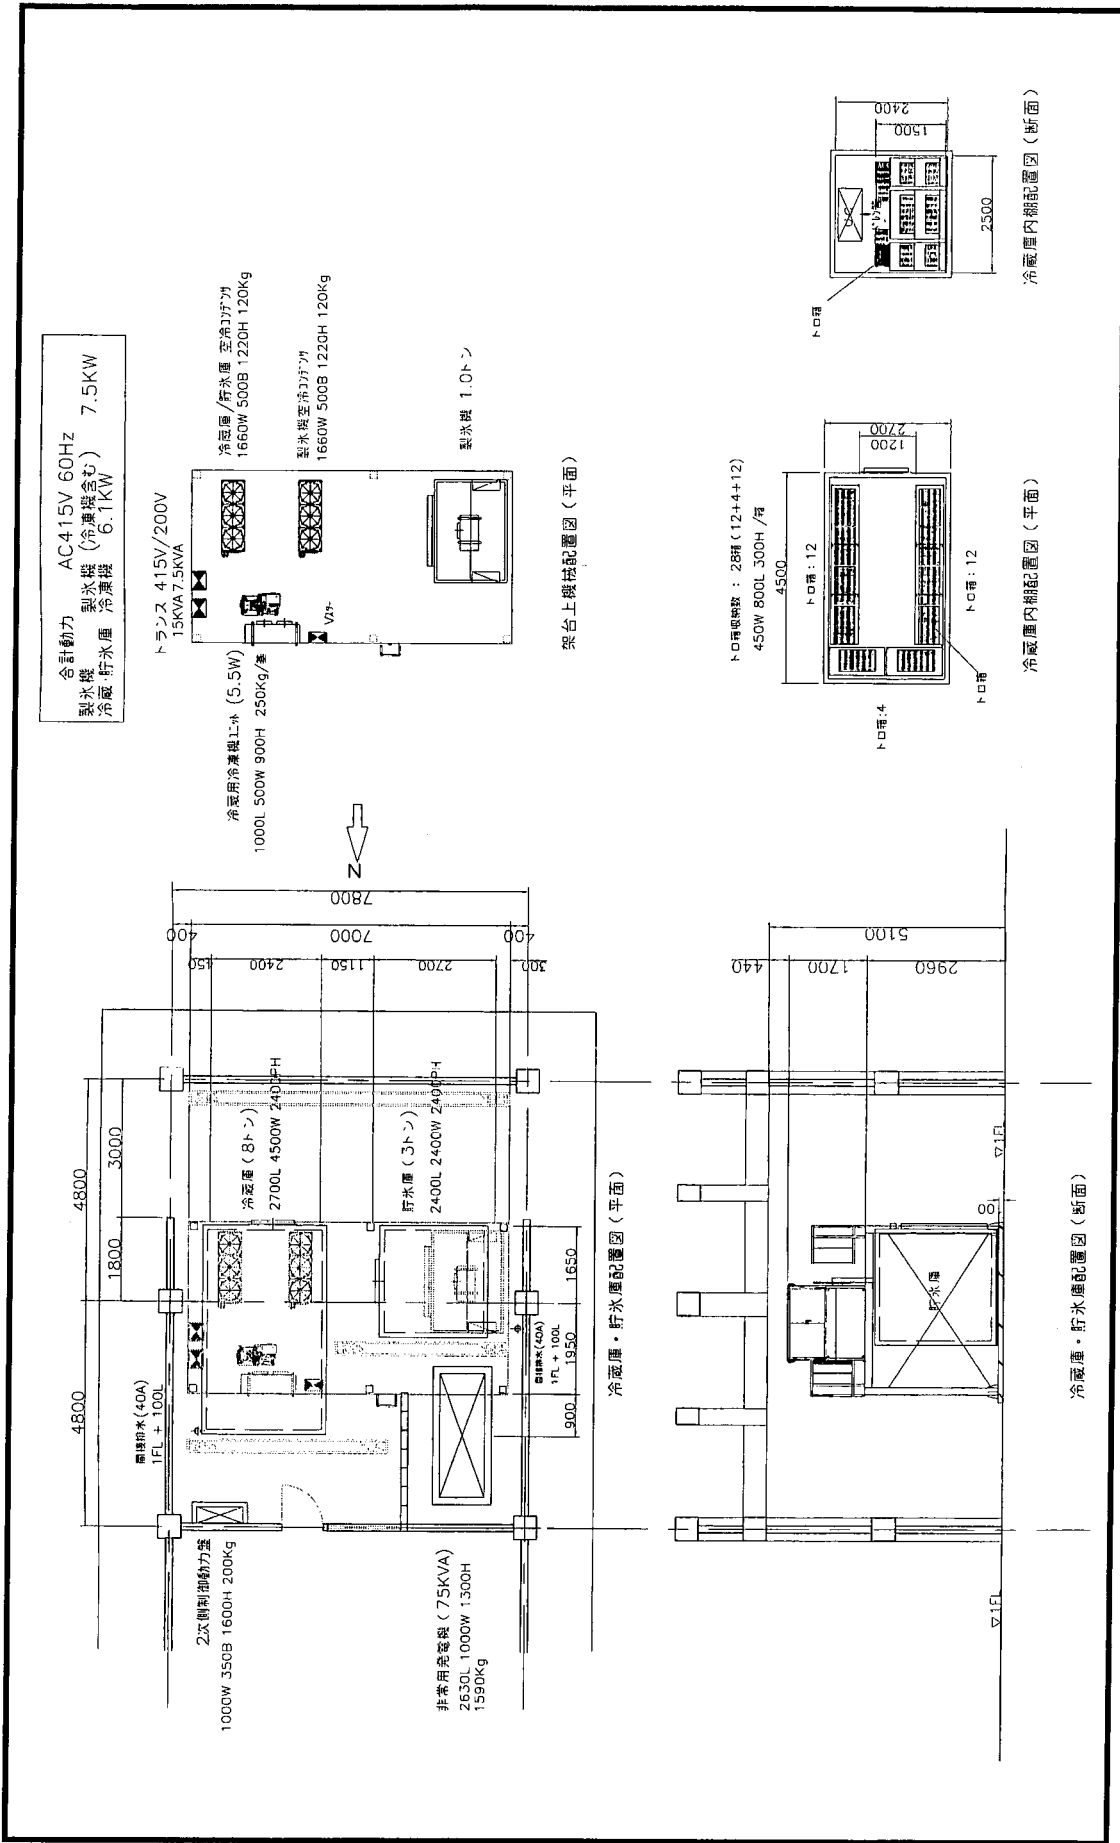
製氷・貯水・冷蔵設備平面計画図
